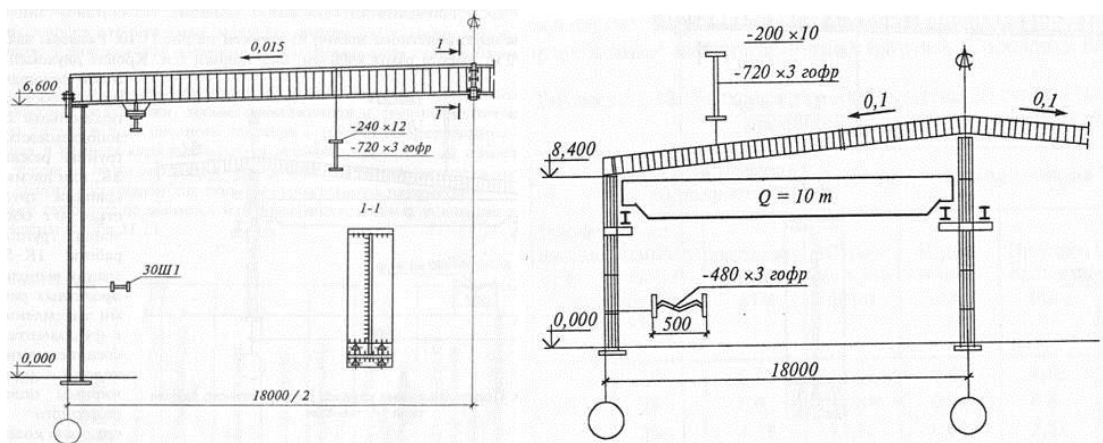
а) поперечная рама каркаса однопролетного здания, б) поперечная рама каркаса двухпролетного здания
